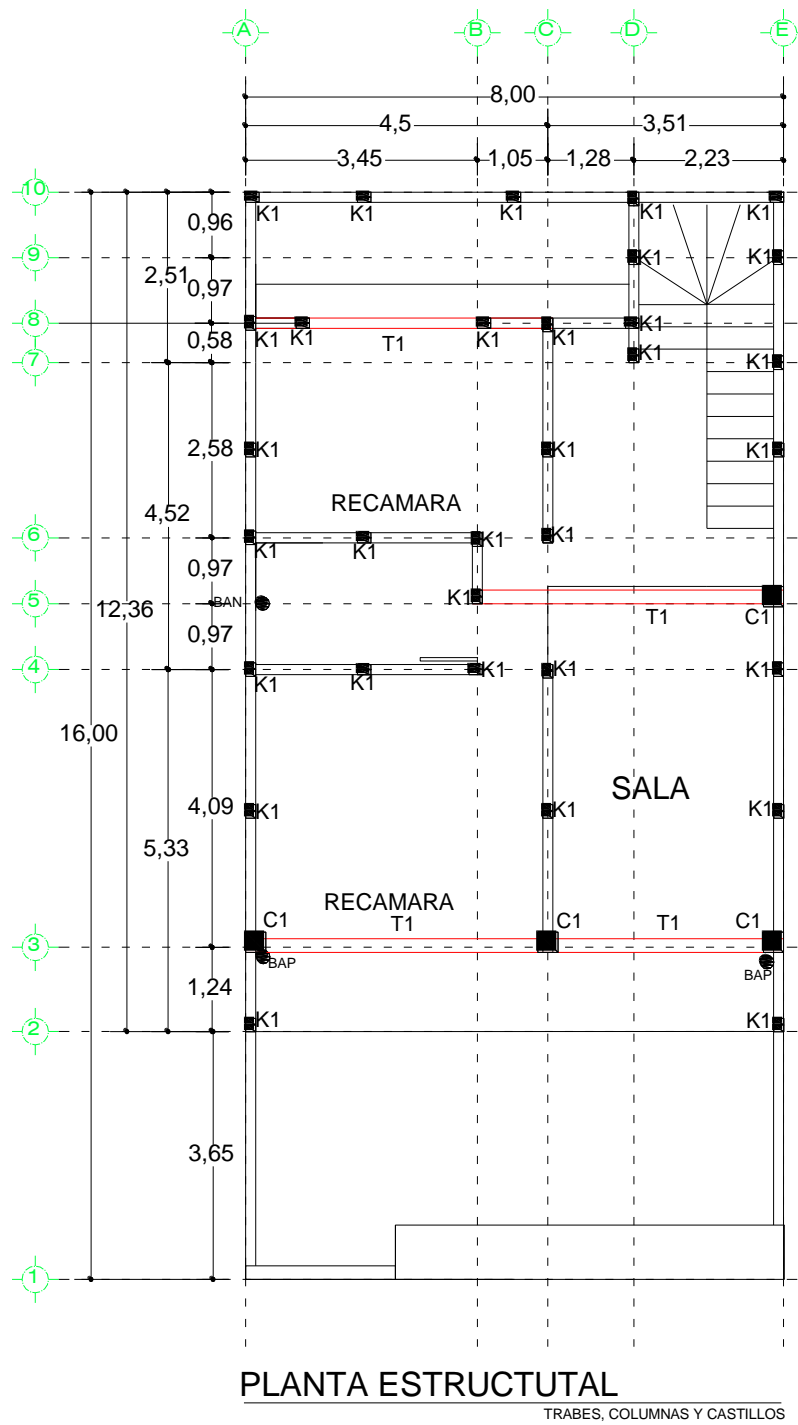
Planta alta estructural trabes, columnas y castillos.
